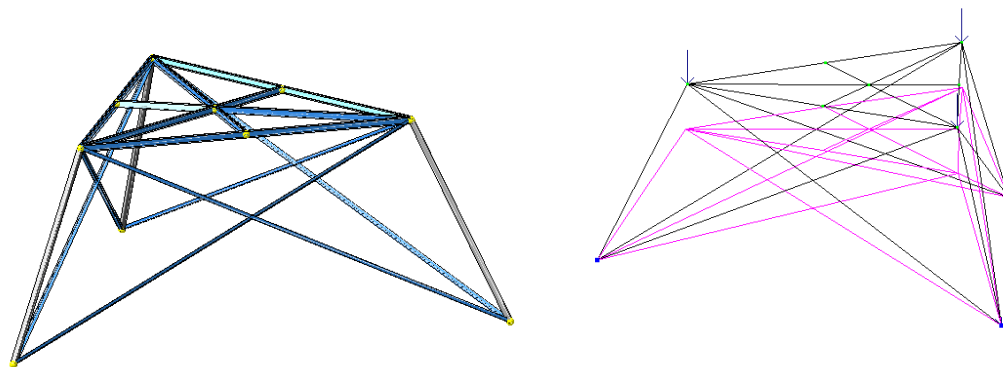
Конструкция опоры, исходный деформированный вид конструкции
